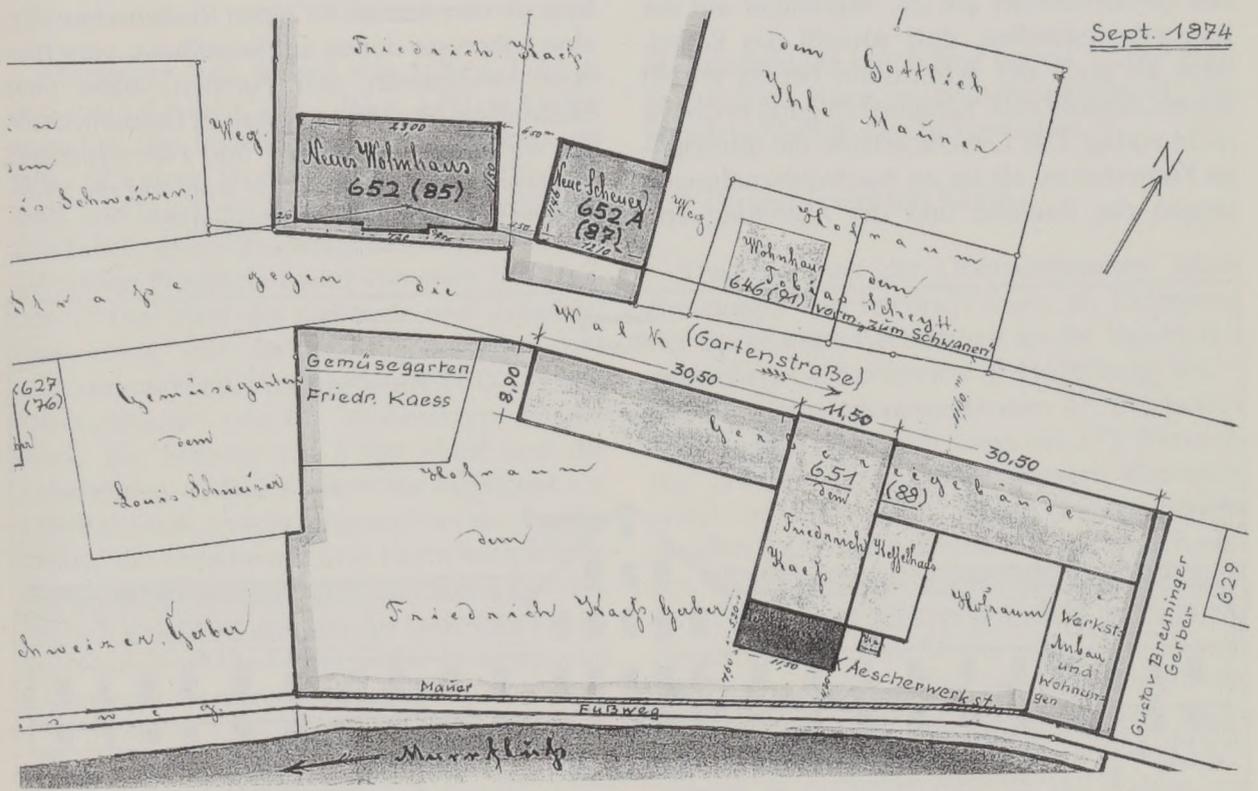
Lageplan der von Friedrich Kaess geplanten Lederfabrik mit Wohnhaus und Scheuer in der späteren Gartenstraße Nr. 85, 87 und 88.
